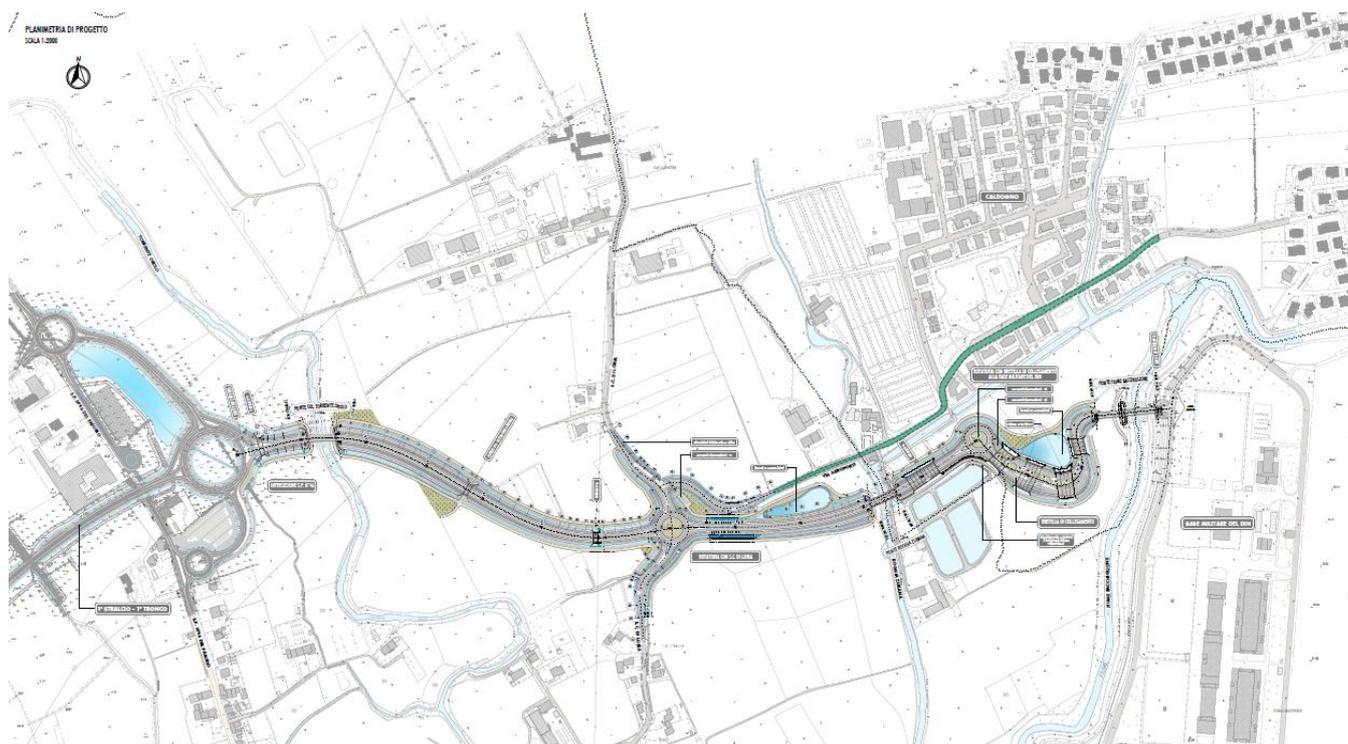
PLANIMETRIA GENERALE DEL 1° STRALCIO - COMPLETAMENTO
